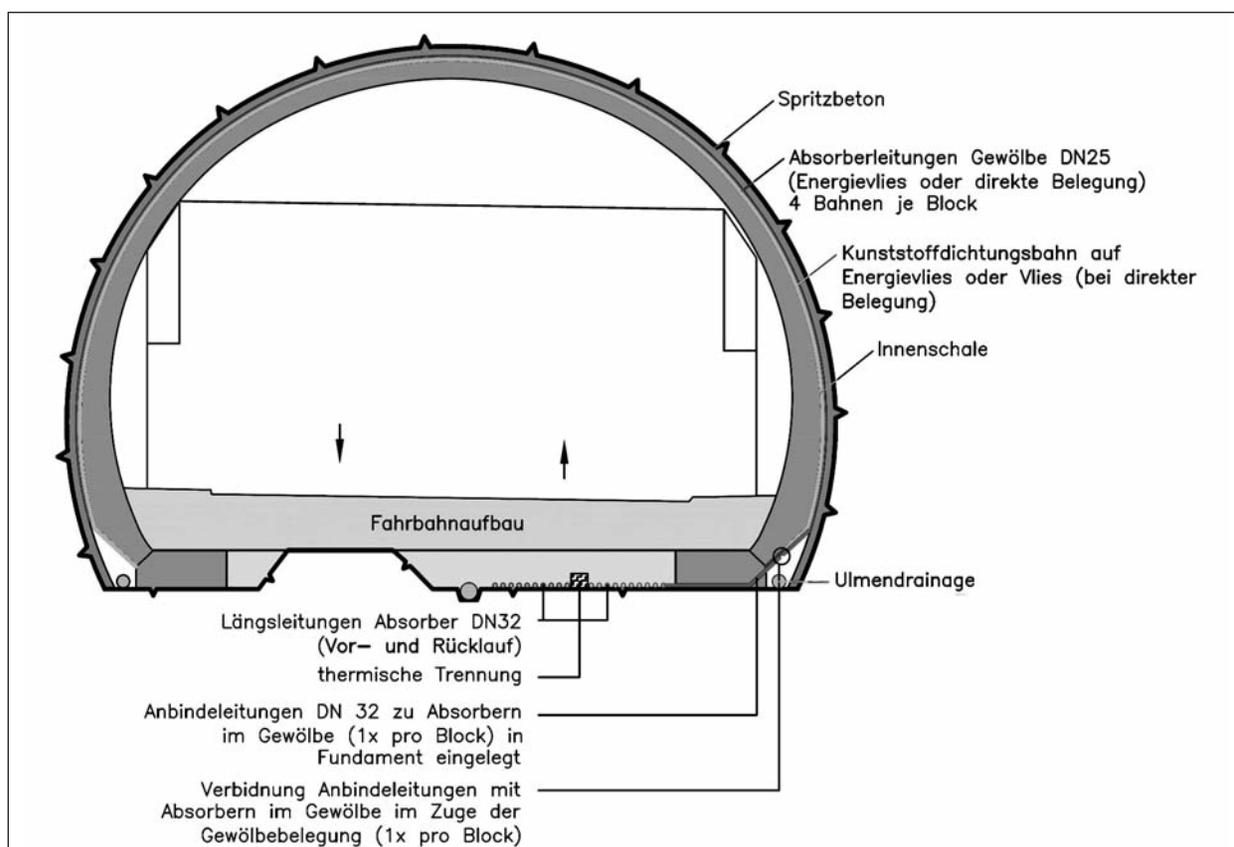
Beispielhafte Situierung von Absorberleitungen in einem Tunnel in geschlossener Bauweise mit Regenschirmabdichtung
